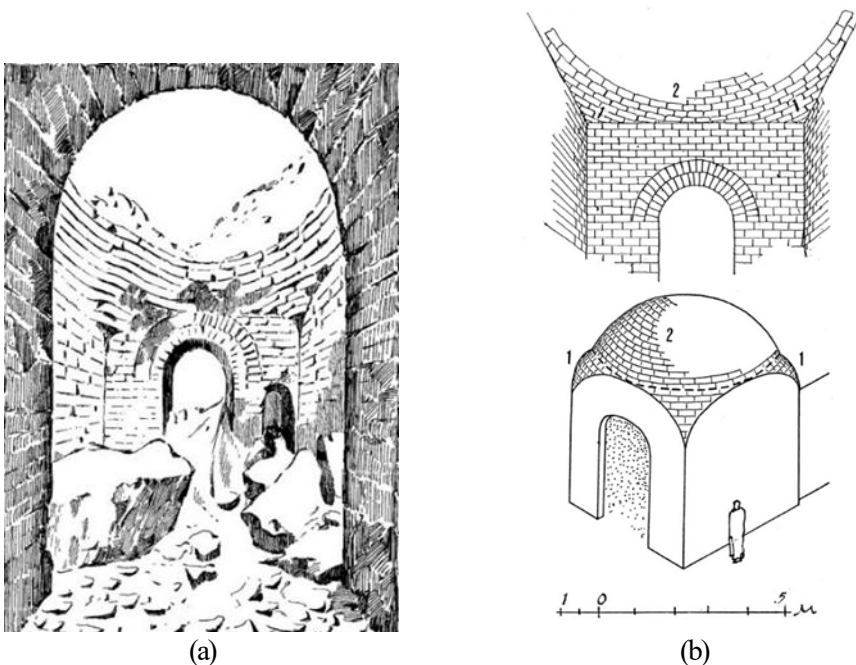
Cúpula em consola em tijolo seco ao sol sobre planta quadrada, Dra Abu el-Naga, perto de tebas, Egito (c. 1500 a.C.): (a) Perspetiva das ruínas da câmara sepulcral; (b) Em cima: vista do interior do remanescente; em baixo: Vista da reconstrução exterior: 1. Trompas em consola; 2. Cúpula esférica em consola.
